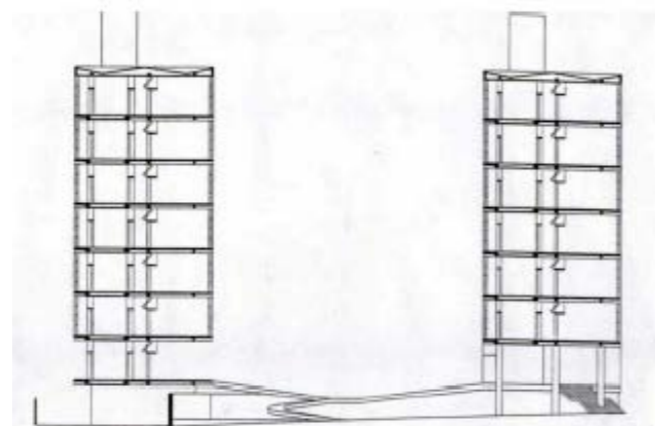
Secção do conjunto. Fonte: Revista 2G.
